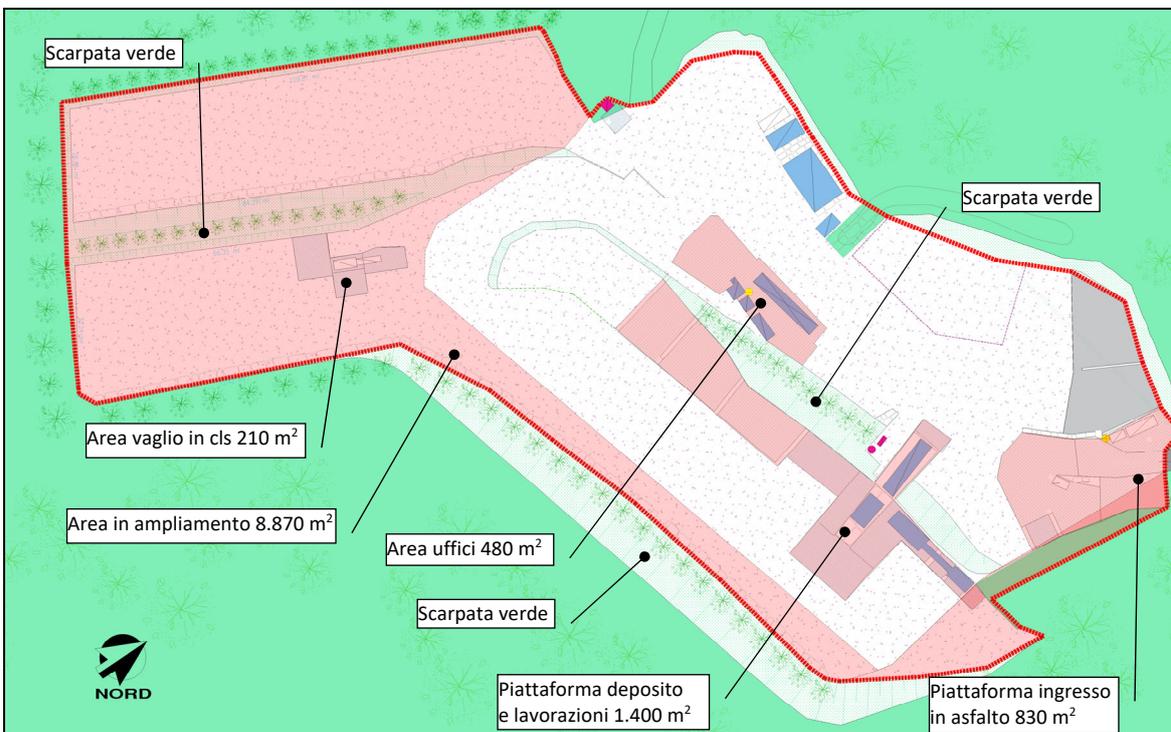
Lotto oggetto dell'intervento con evidenziate le aree di sistemazione finale (rosso)
